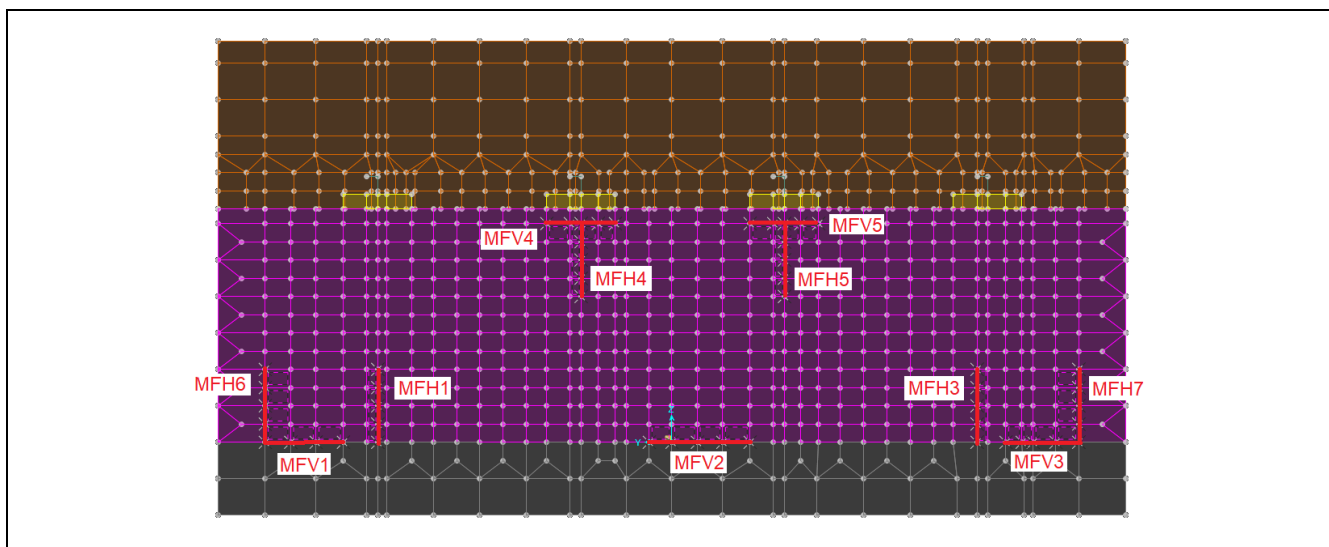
Sezioni di verifica della spalla - muro frontale
